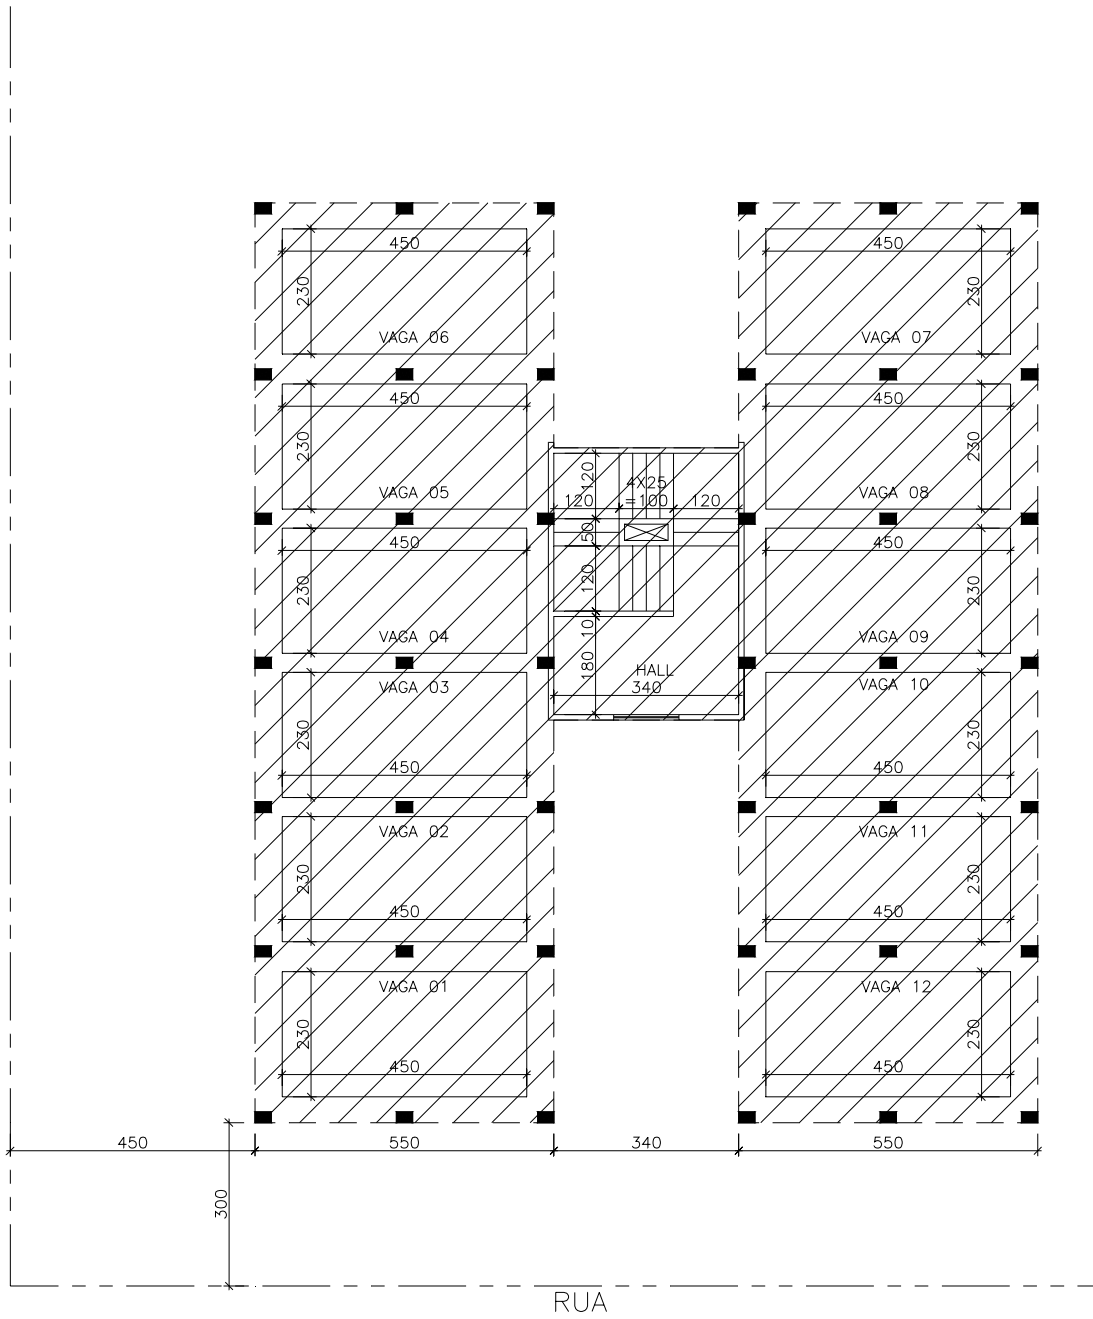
Residencial “SF” – Projeção do Pavimento Tipo sobre as garagens
